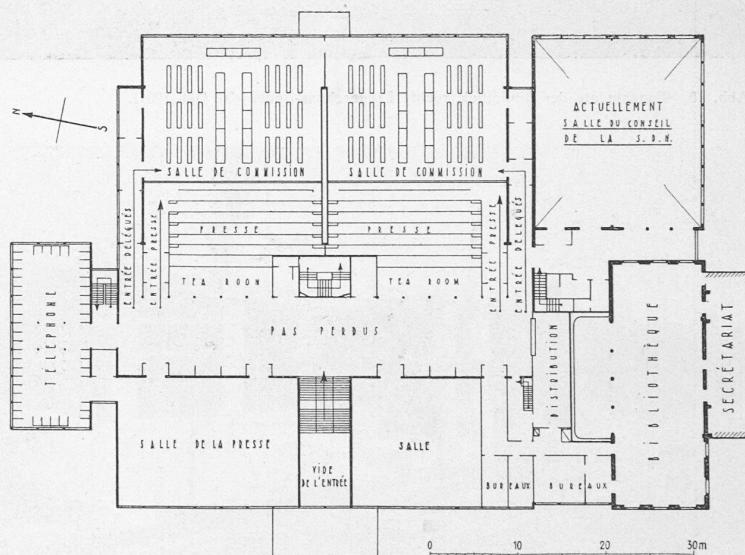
Grundriss vom Hauptgeschoß (1. Stock). — Maßstab 1 : 800.
